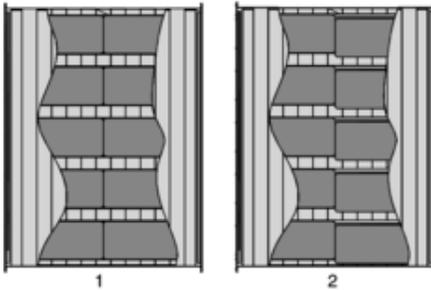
Installation avec la même largeur de passage d'air entre les baffles
